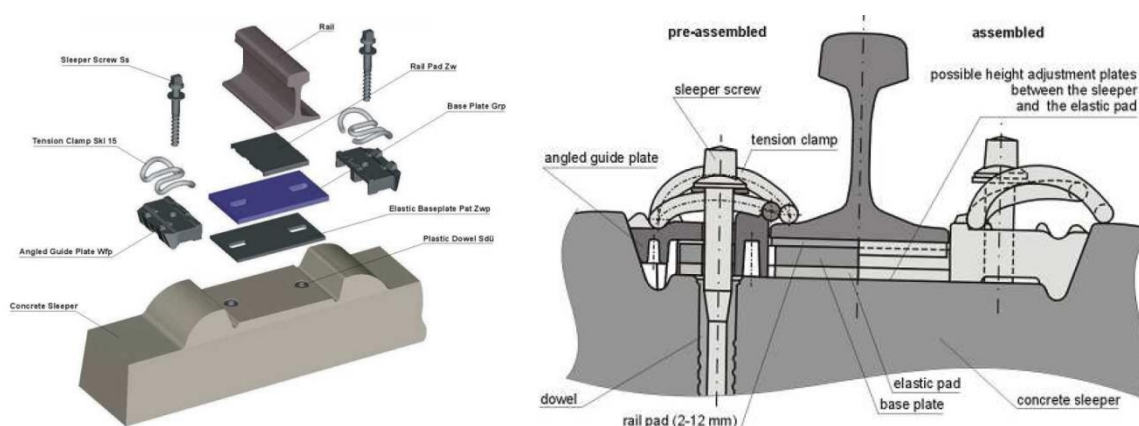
Pormenor do sistema de fixação 300 da Vossloh, indicado para via em laje (Winter, 2007)
